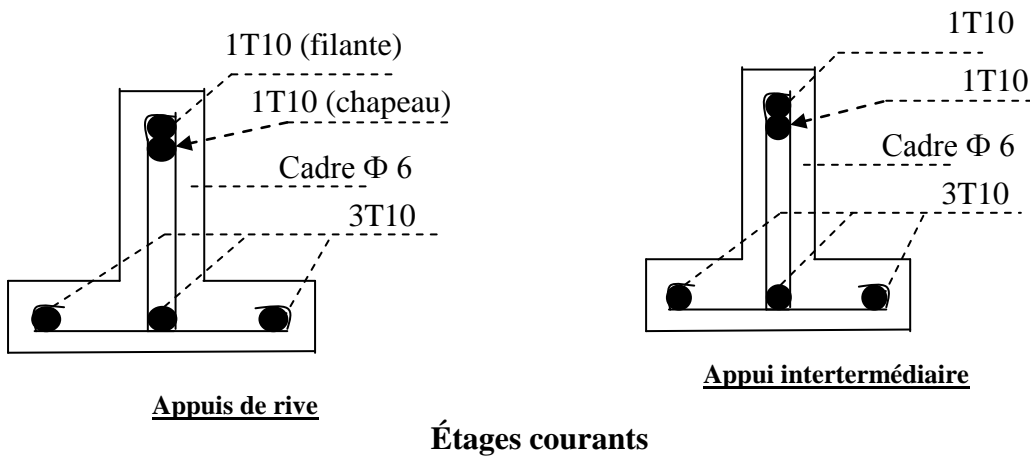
Dessin de ferrailage des poutrelles des étages courants.
